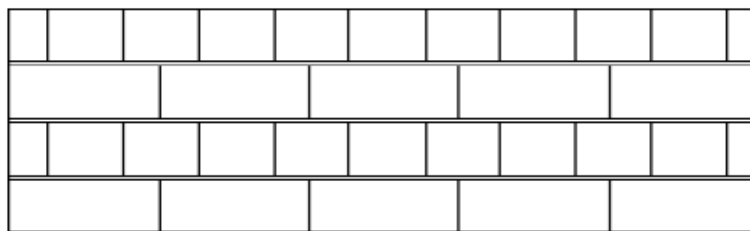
parement du mur en maçonnerie de parpaings spéciaux
